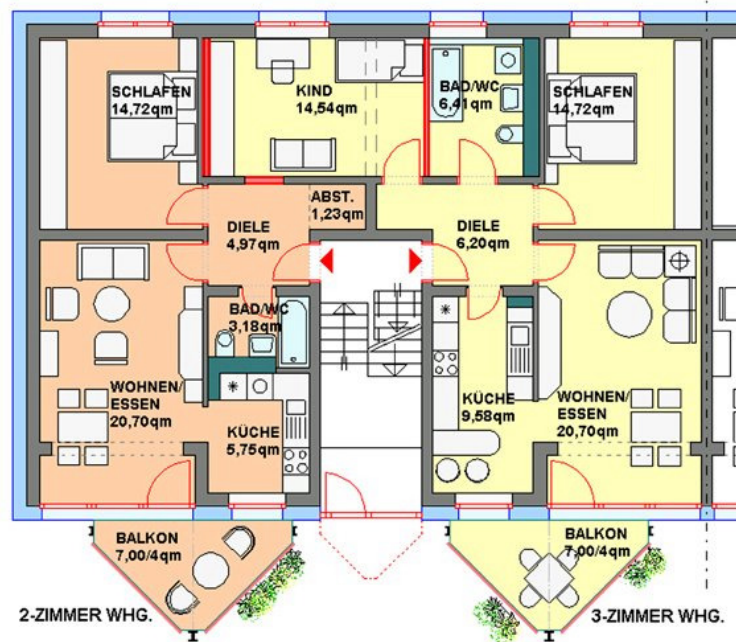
Grundriss EG mit zwei Wohnungen, mit dem Hauseingang und Treppenhaus. Die anderen drei Eingänge und die jeweils beiden Geschosse sind identisch aufgeteilt (Quelle: GAG Ludwigshafen).
